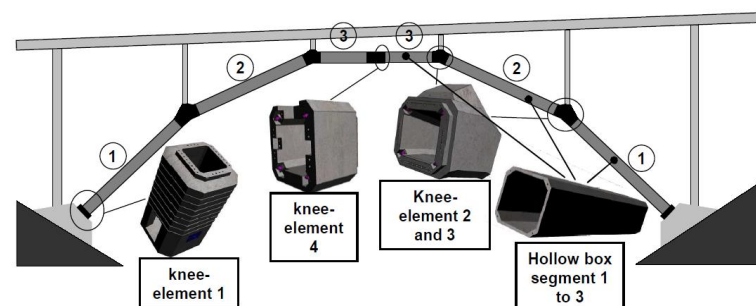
Síntesis de elementos que forman el puente WILD y detalle del elemento de conexión [Reichel et al. 2009]
